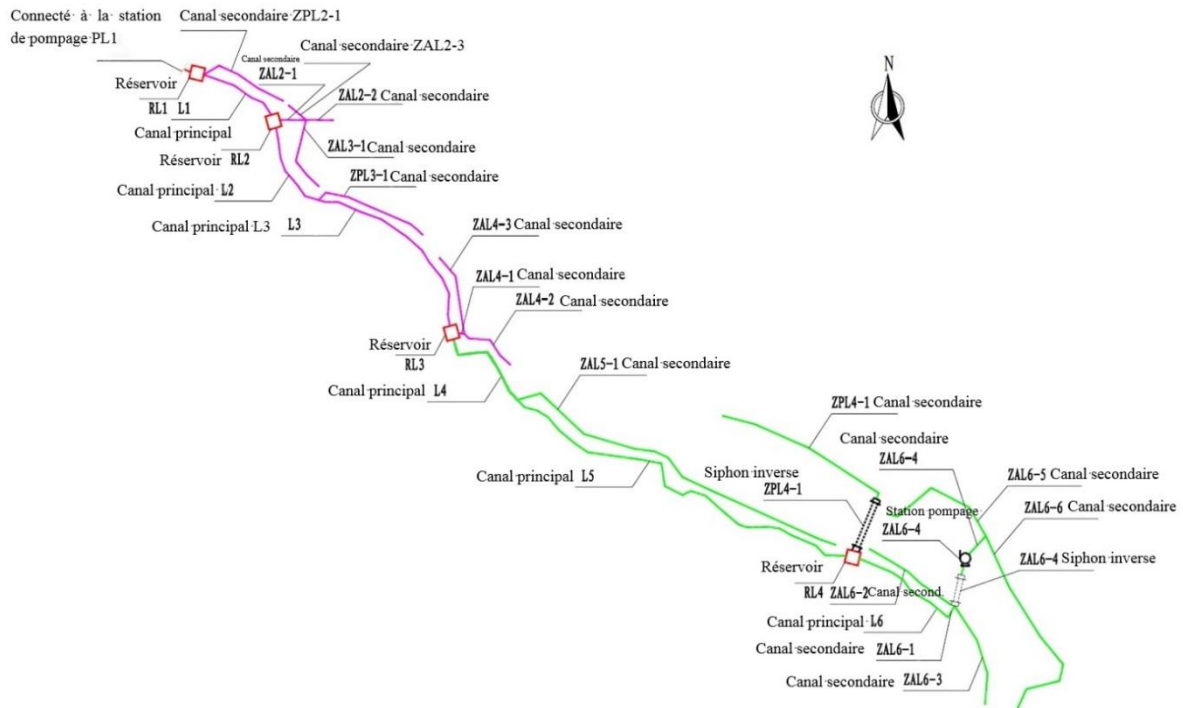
Plan d'aménagement des canaux principaux et secondaires de l'ouest I
